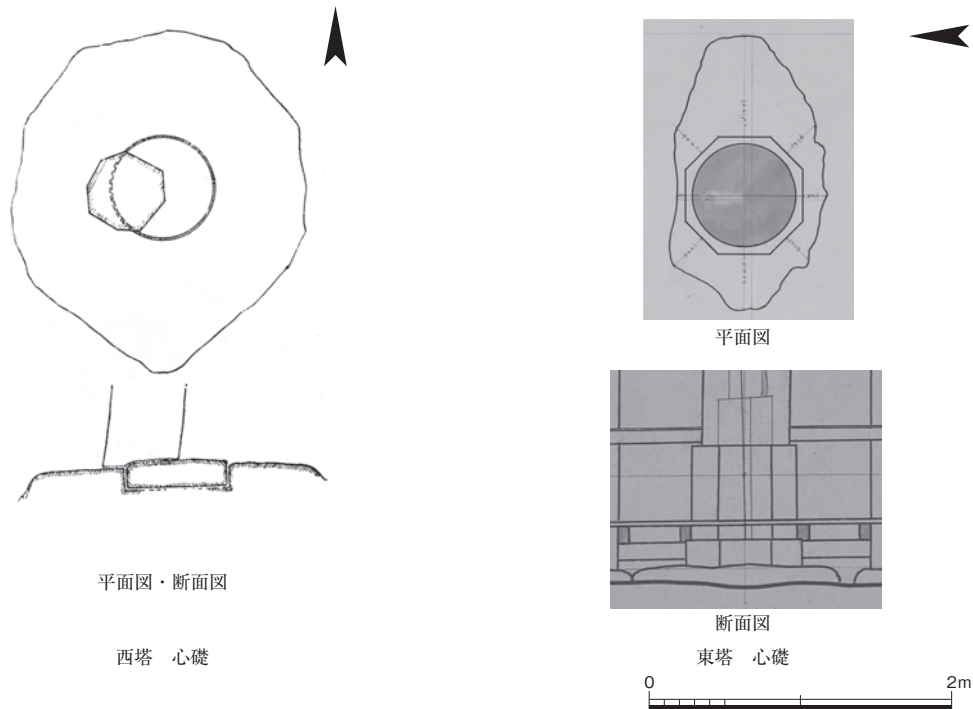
当麻寺東西塔心礎 平面図・断面図 1:50
